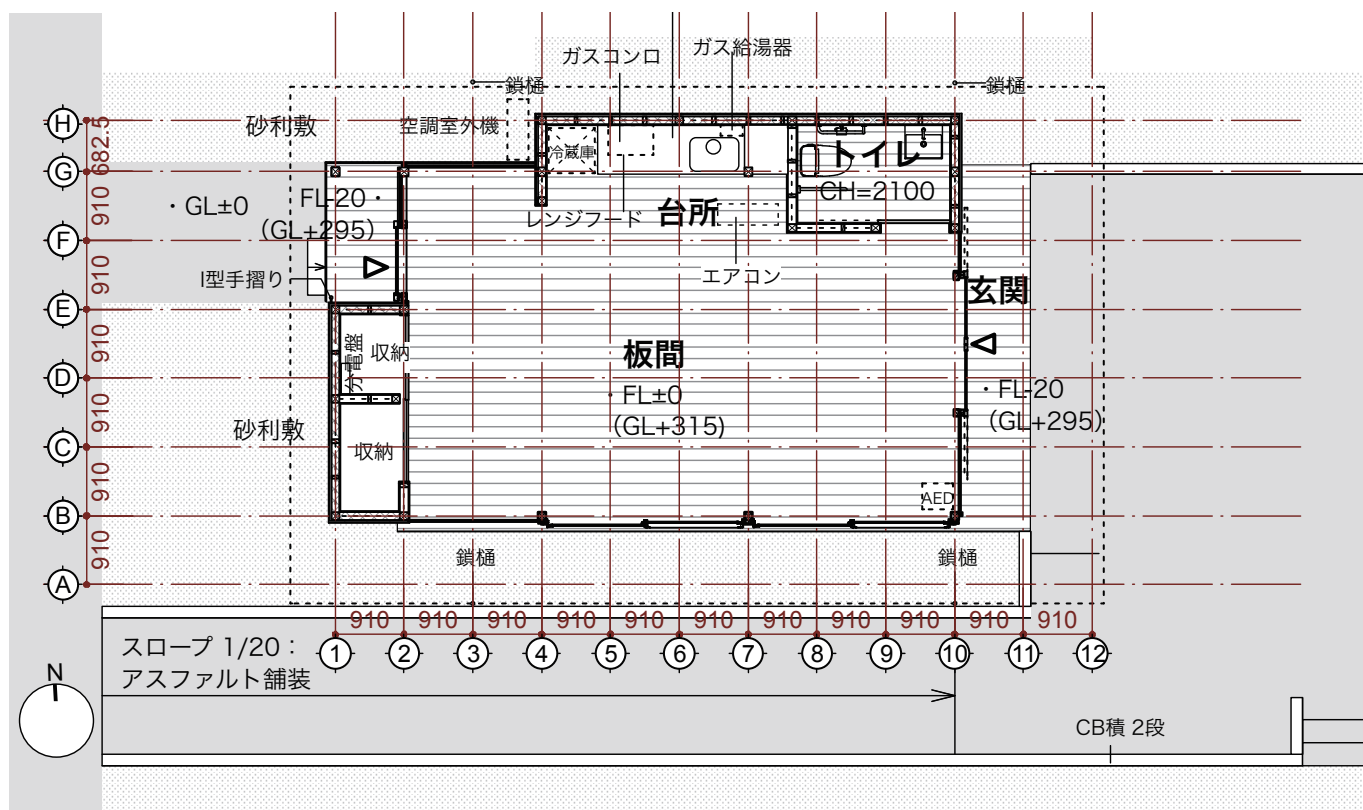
平面図 (S=1:100) 東峰村団地集会所
